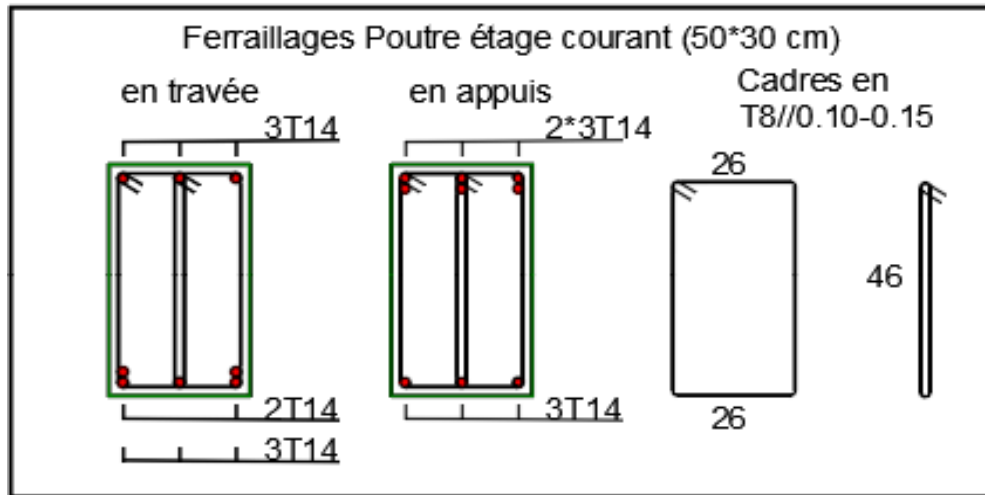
Ferraillages Poutre étages courants 30*50 cm.
